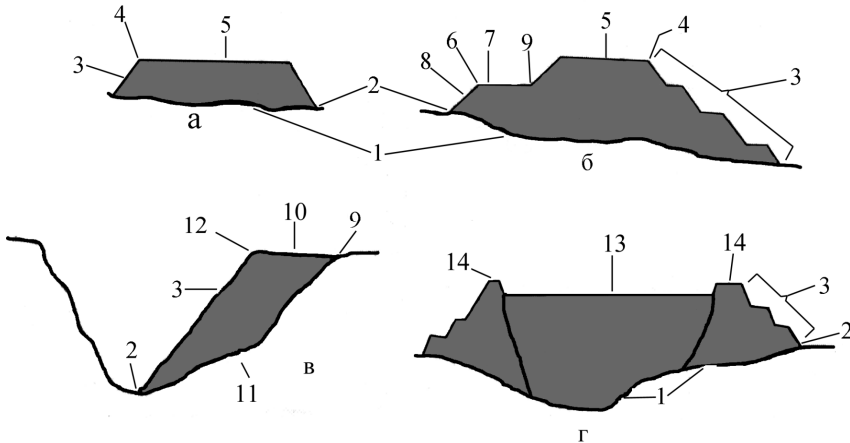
Морфологічні типи відвалів: а – одноярусний платоподібний; б – багатоярусний платоподібний; в – притулений засипний; г – багатоярусний платоподібний шламосховищ. Морфологічні елементи відвалів: 1 – підношва; 2 – підніжжя; 3 – схил; 4 – бровка плато; 5 – поверхня плато; 6 – бровка ярусу; 7 – площадка ярусу; 8 – схил ярусу; 9 – тилловий шов; 10 – поверхня засипання; 11 – поверхня дотику; 12 – бровка поверхні засипання; 13 – поверхня тіла шламосховища; 14 – дамба з площадкою і бровками.
